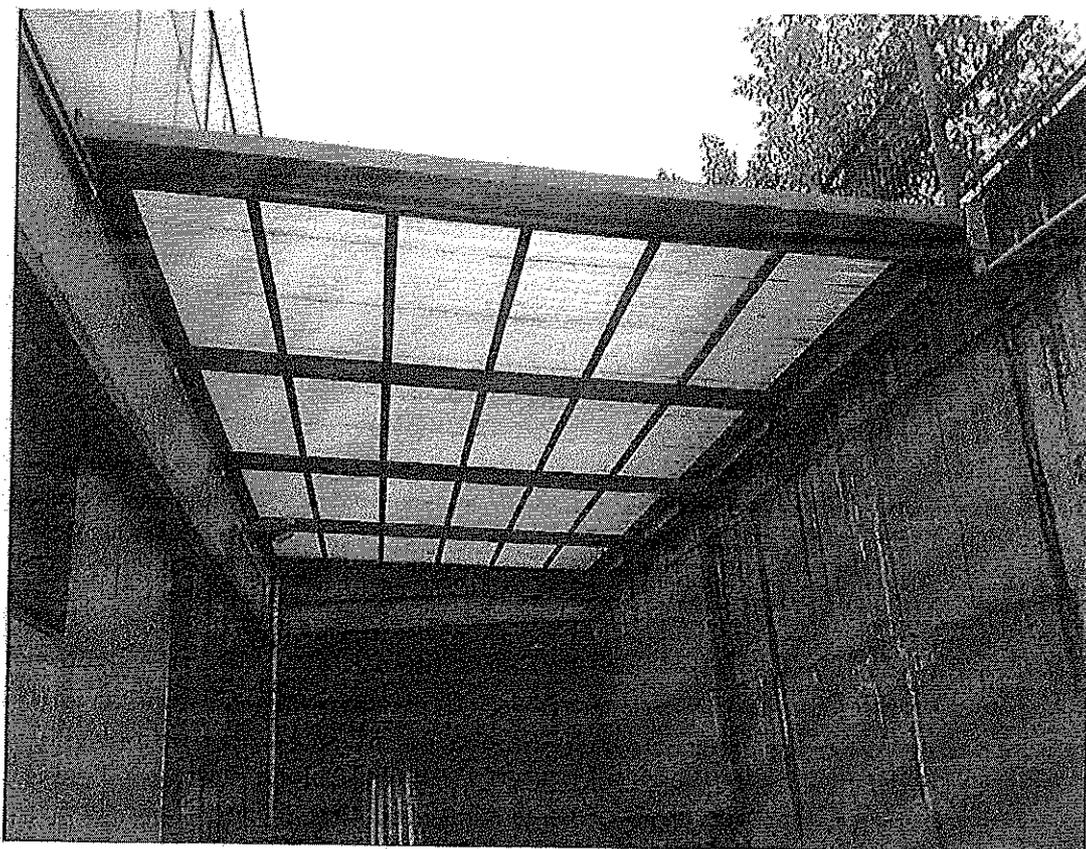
Tettoia metallica nel fronte Est del complesso produttivo.
